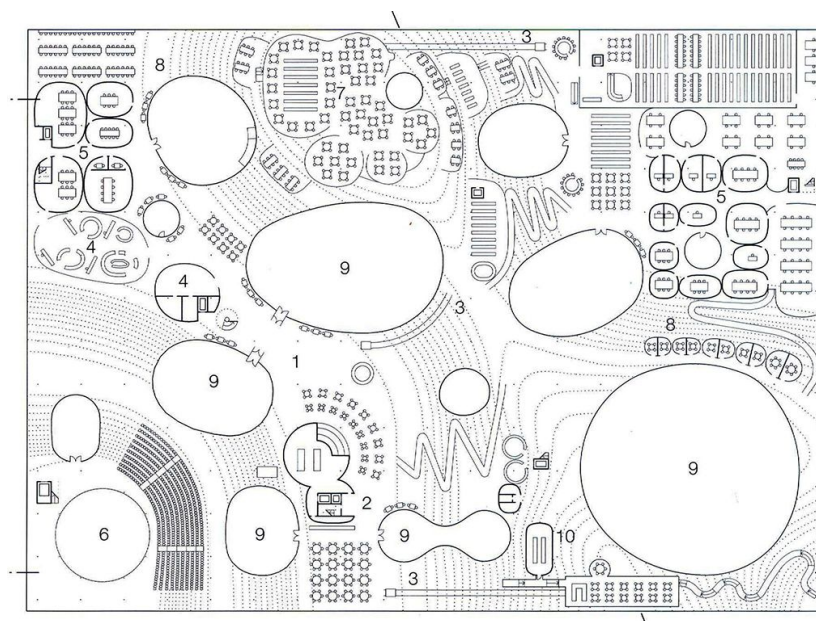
Planta Arquitectónica- "Rolex Learning Center", SANAA. 2010.
